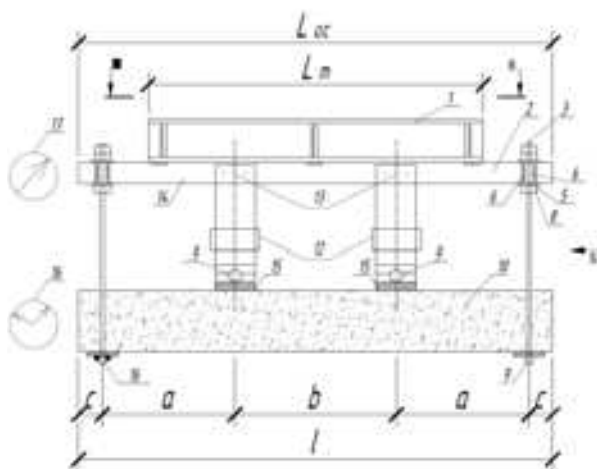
Схема экспериментальной установки для исследовательского испытания железобетонного балочного элемента на изгиб. Вид спереди
